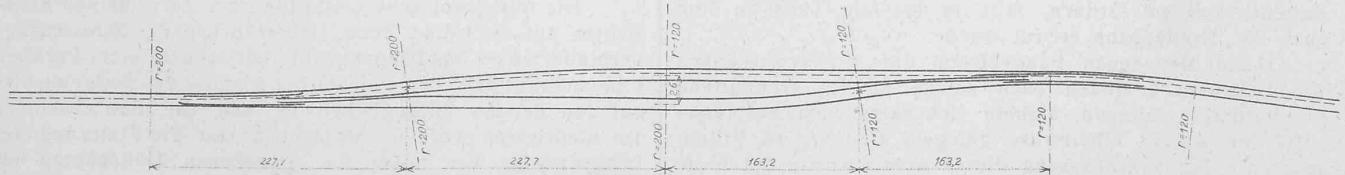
Lageplan der Ausweichestelle. — Maßstab 1:1500.
